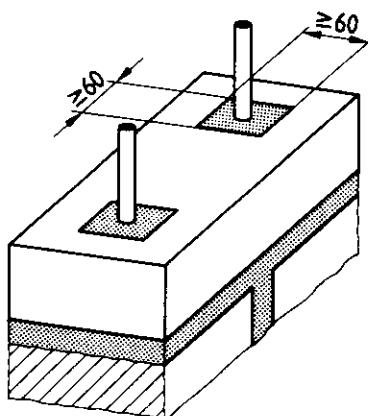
Vertikale Bewehrung in Formsteinen mit kleiner Aussparung (Prinzipskizze)
